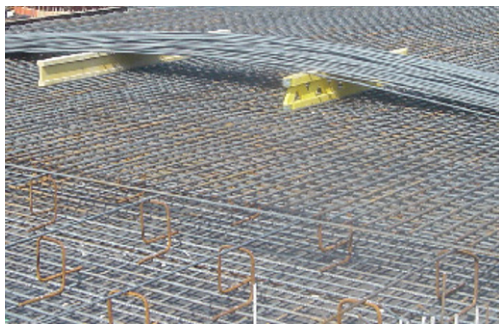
Belastung einer Bewehrung noch vor der Fertigstellung und unmittelbar während des Betonierens
